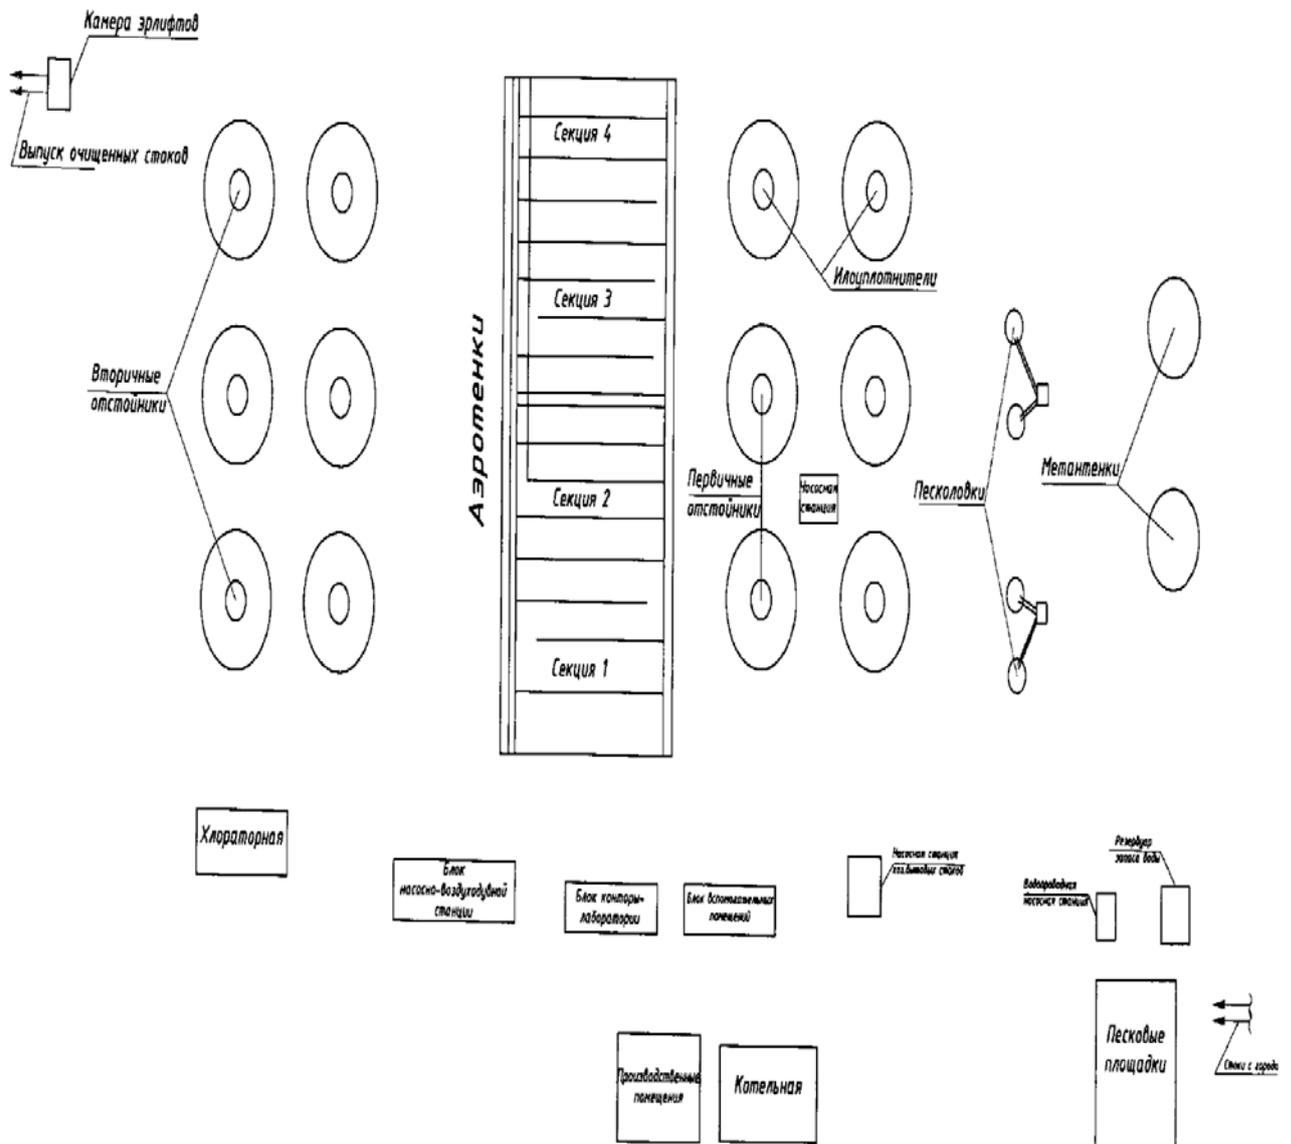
План левобережных очистных сооружений
